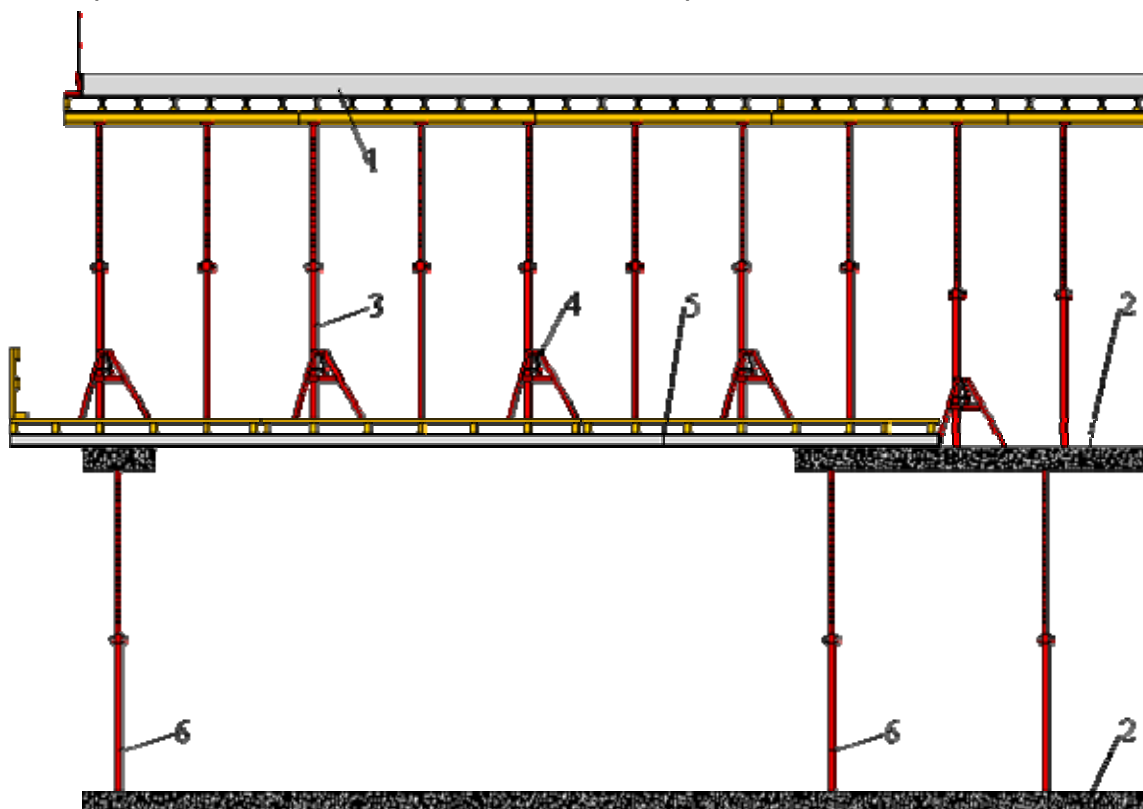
Схема устройства консольной площадки для опалубки перекрытия:
